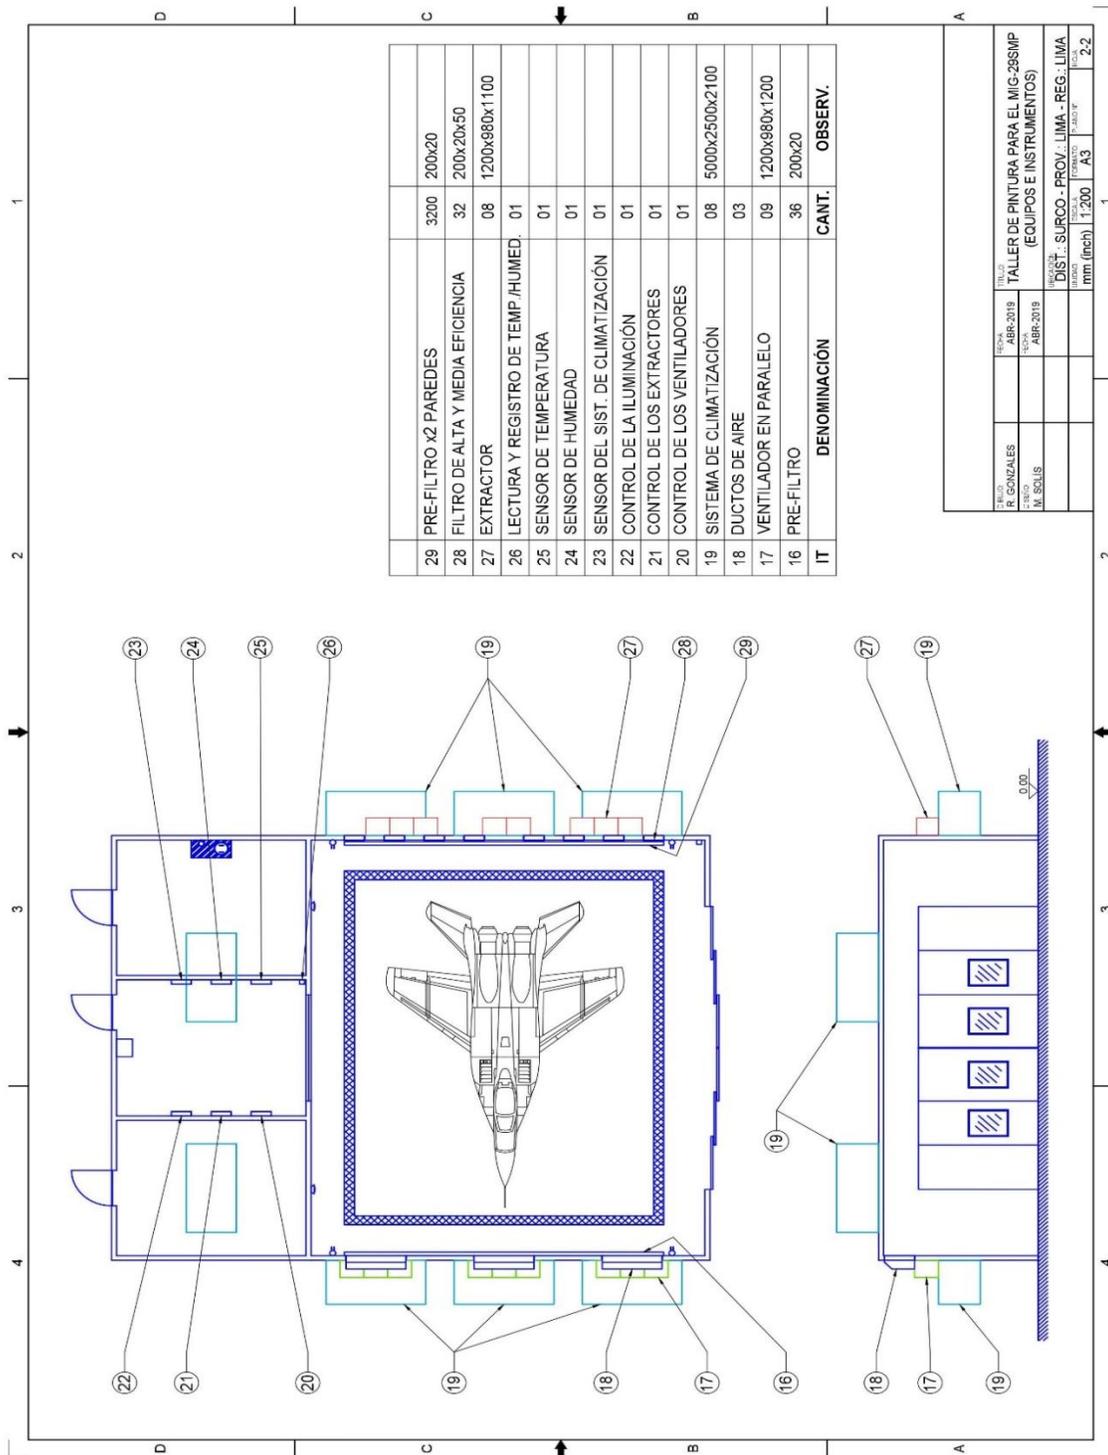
Plano en vista de planta y en vista frontal 2 de 2. Elaboración propia
